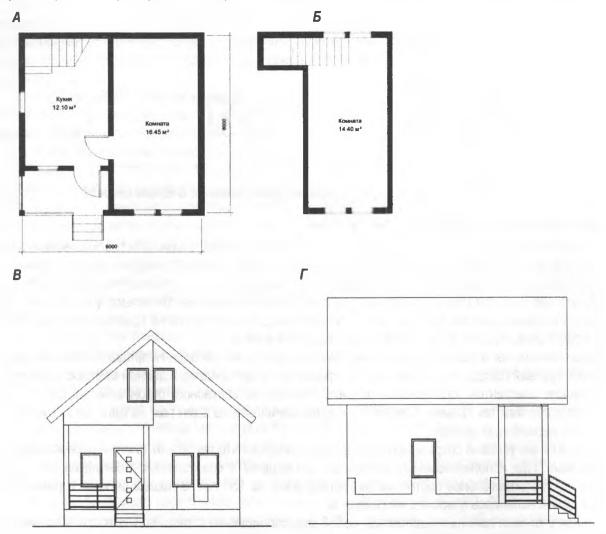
А-план 1-го этажа; Б- план 2-го этажа; В-фасад фронтальный; Г-фасад боковой
